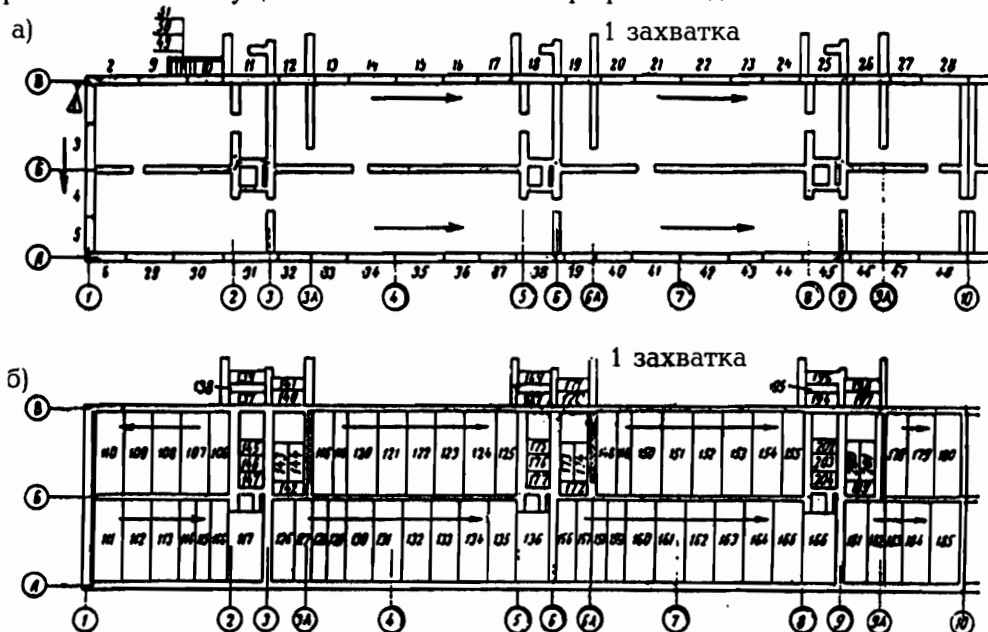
Технологическая последовательность монтажа цокольных панелей и плит перекрытия над техническим подпольем подземной части здания с продольными несущими стенами: а – монтаж цокольных панелей; б – укладка плит перекрытия
